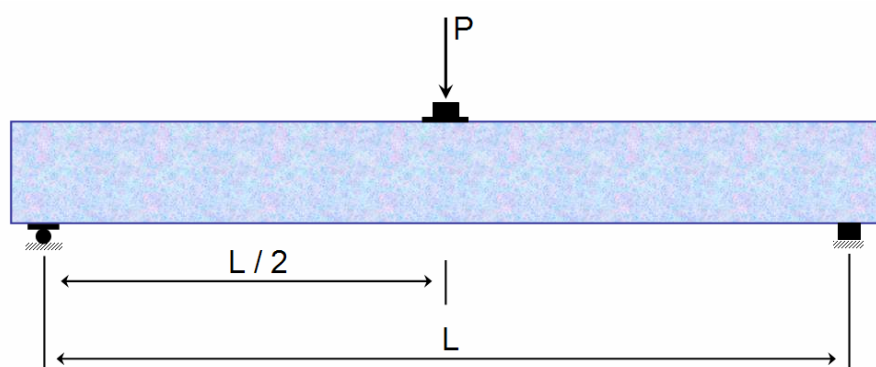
Desenho esquemático das vigas ensaiadas por Bresler e Scordelis (1963).
